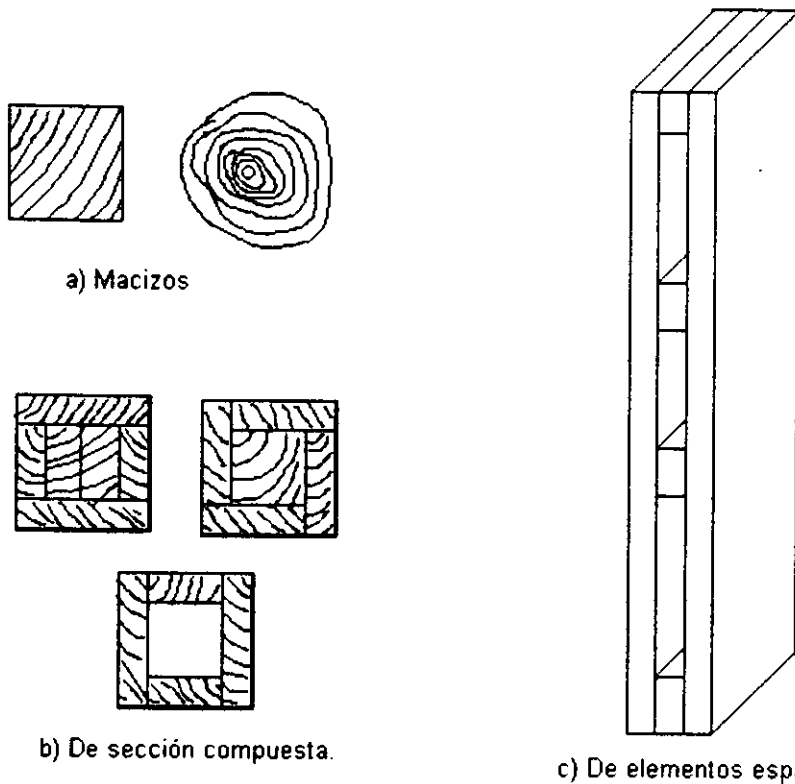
Tipos de miembros de madera sometidos a compresión.
